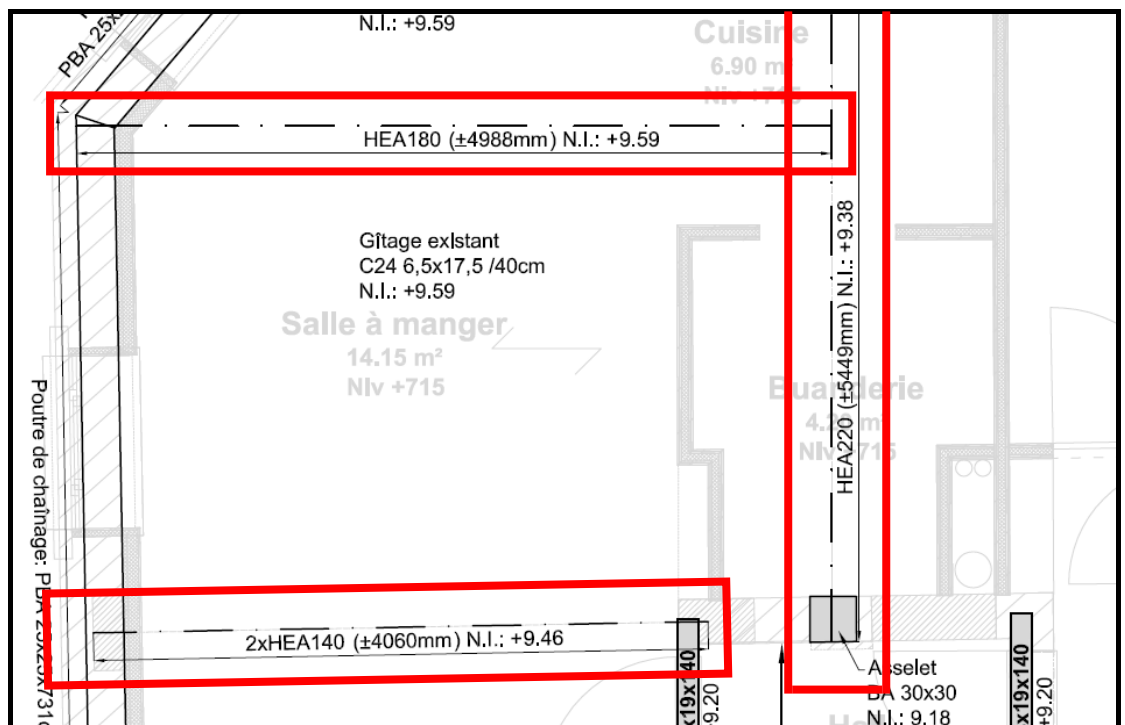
poutres métalliques encastrées dans la maçonnerie – plans d'ingénierie
